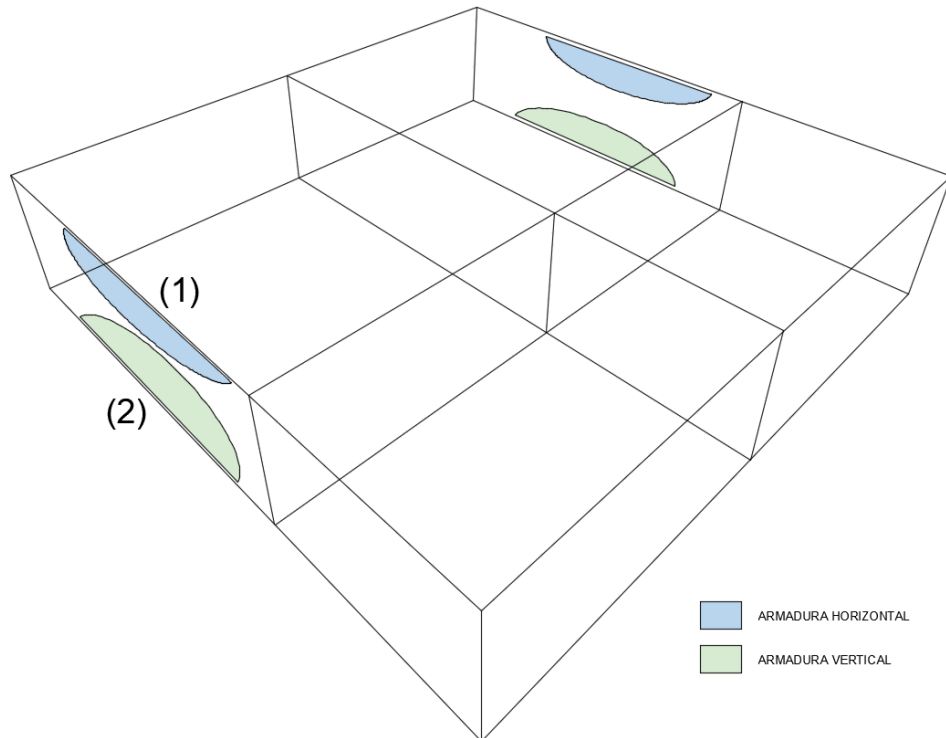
Comprobación de fisuración en zonas de refuerzo en muros externos
